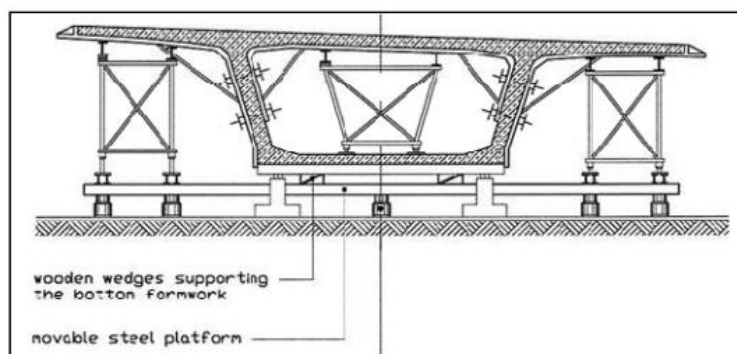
Seção transversal da aduela posicionada para execução do empurramento (França, 2011)
